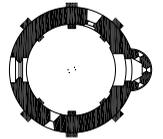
Grundriss BDA Wien. M 1:400.
